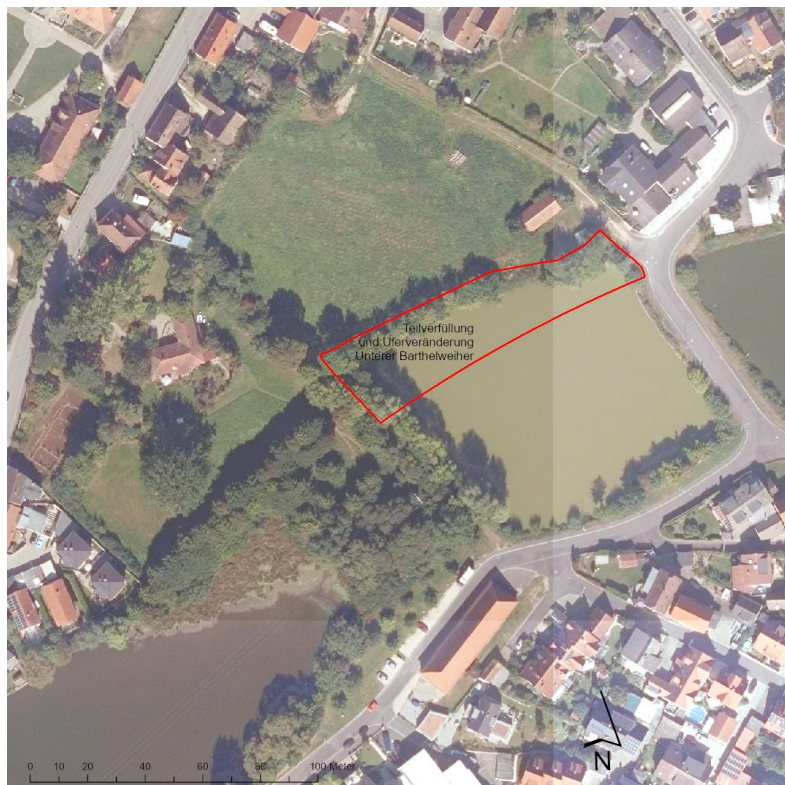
Lageplan Unterer Barthelweiher mit Bereich der Verkleinerung (rote Umrisslinie)
